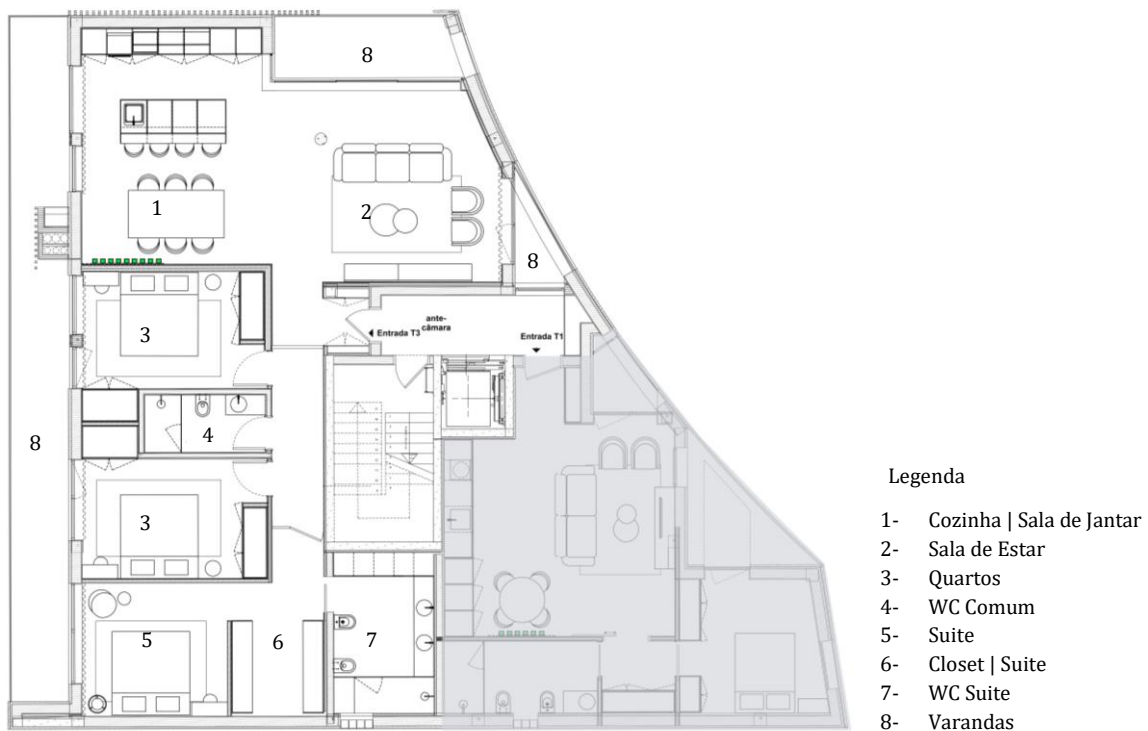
Planta final do apartamento T3. Fonte: 2L' atelier
